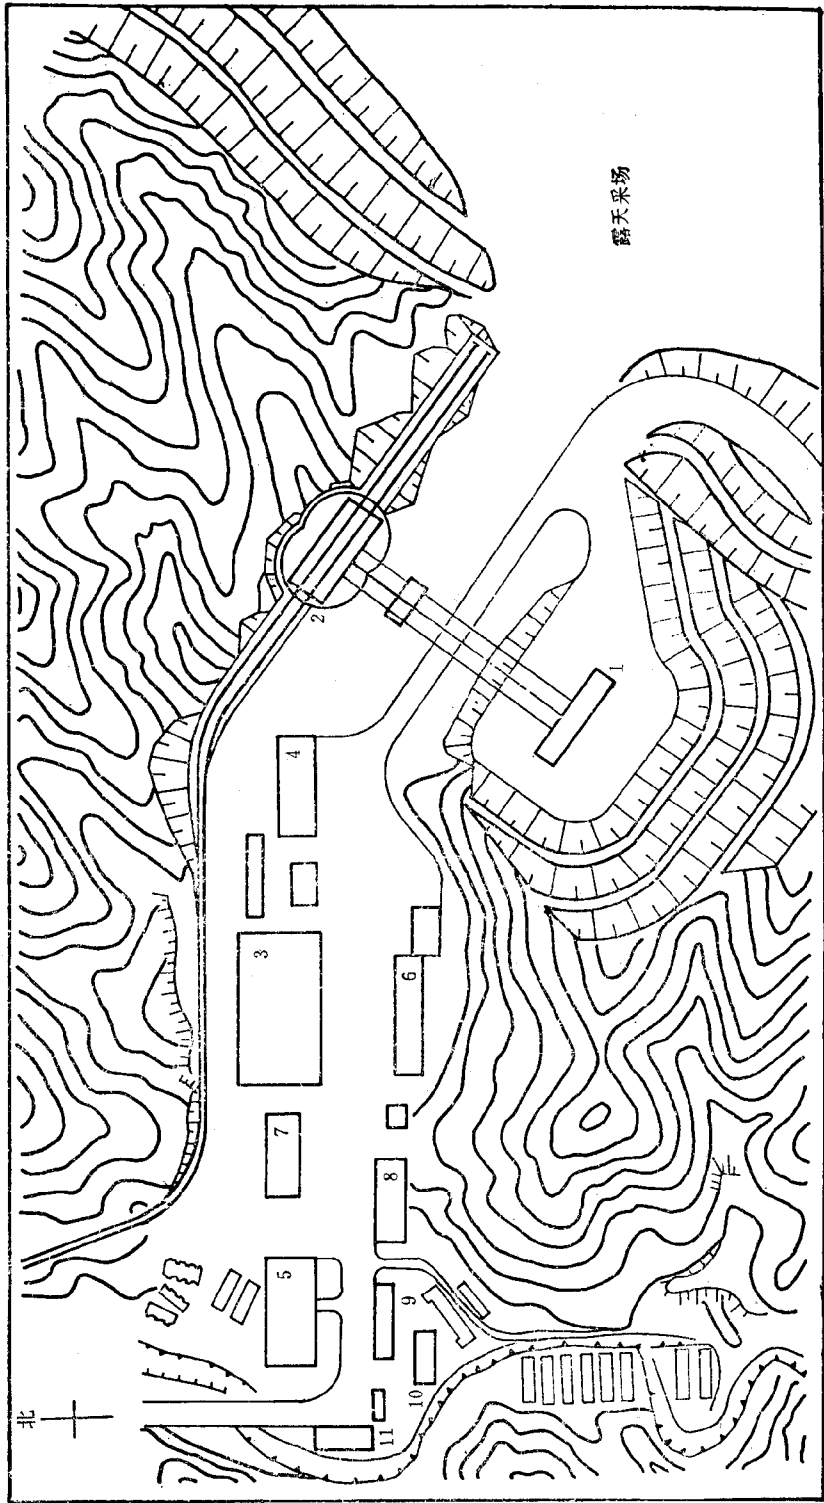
德兴铁矿露天开采工业场地总平面布置图
